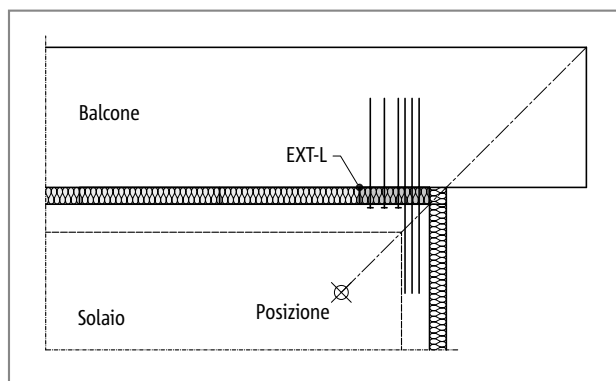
Schöck Isokorb® tipo EXT: balcone a sbalzo lungo l'angolo dell'edificio (impiego tipo EXT-L)
